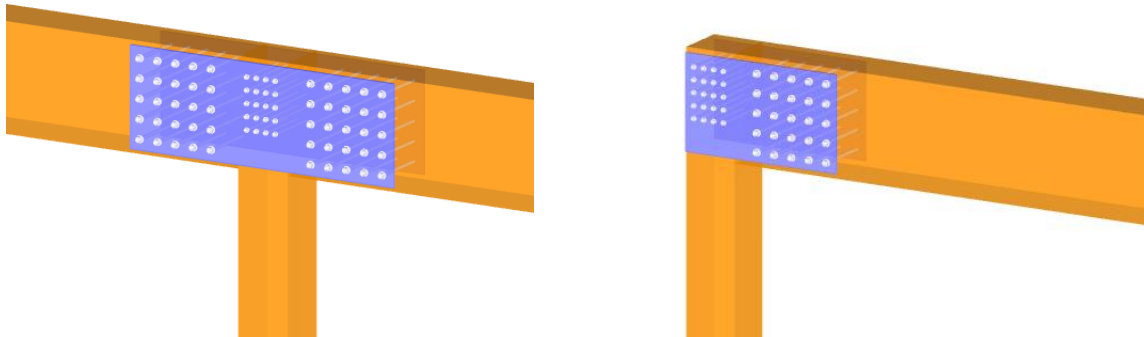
Uniones entre columnas y vigas de la planta baja del edificio principal: unión intermedia (izqda.); unión en esquina (dcha).
